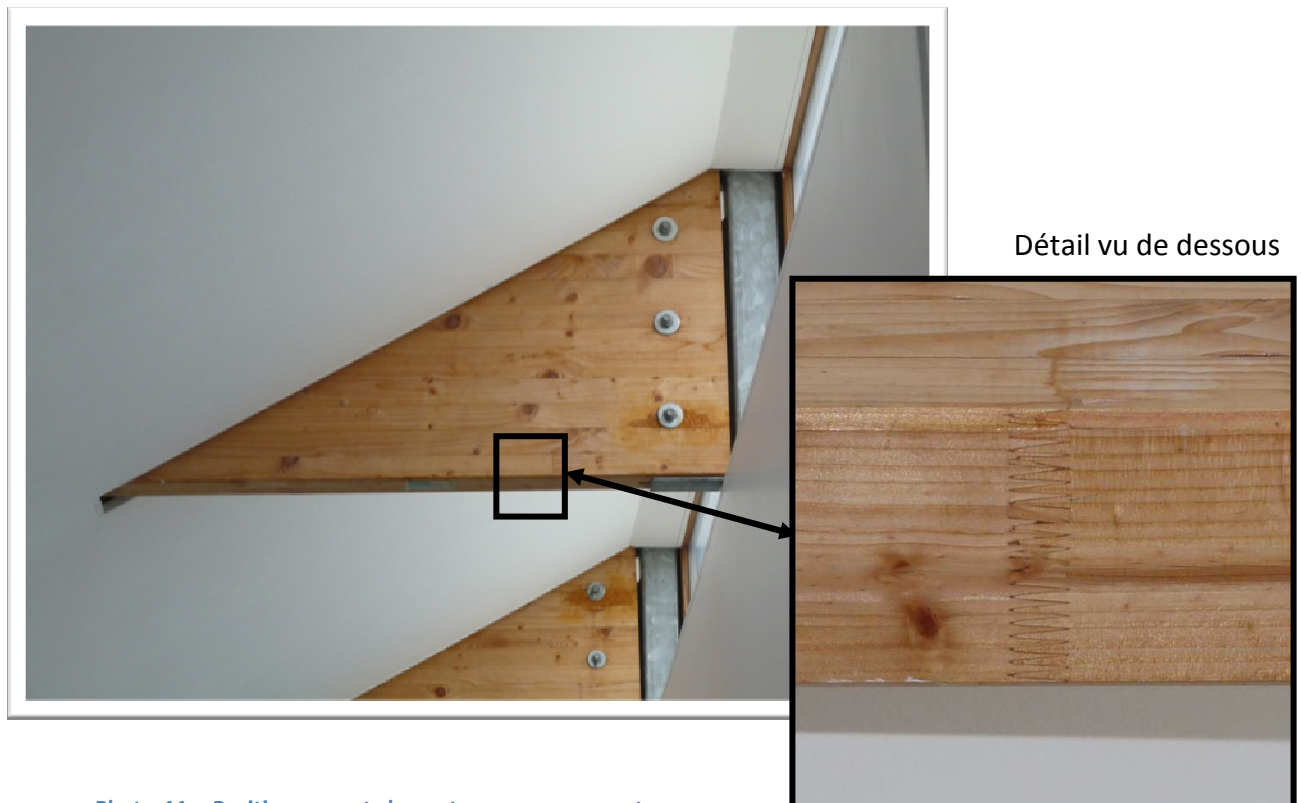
Positionnement des entures sur une poutre lamellé-collé à forte inertie
